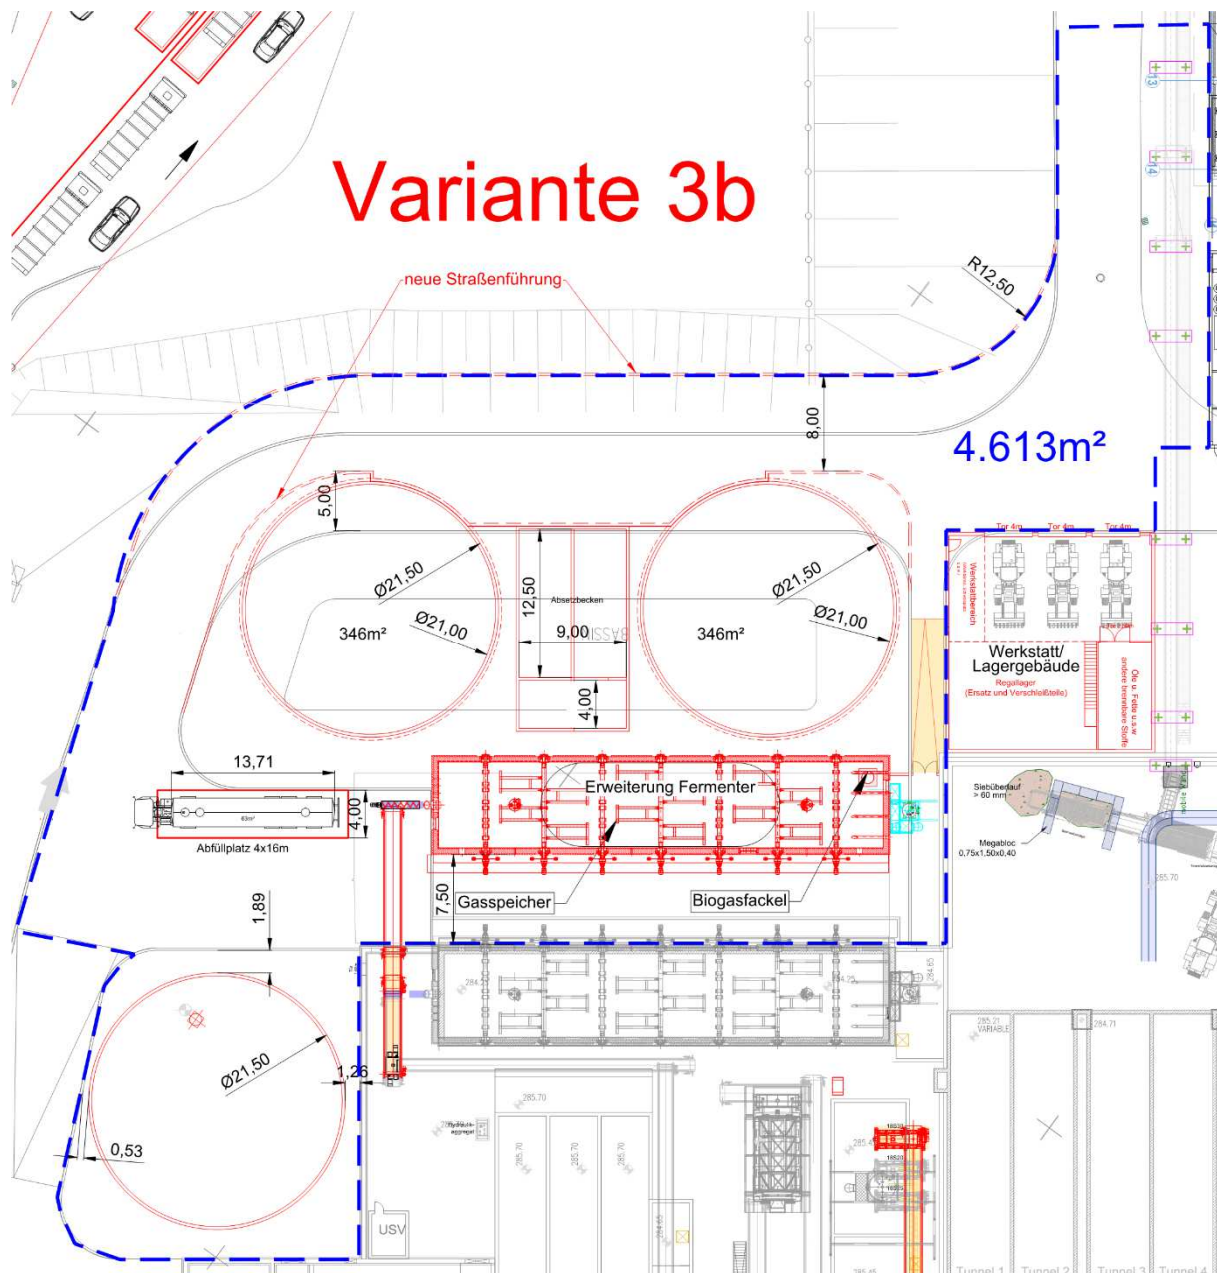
Plan der Minett Vergärungsanlage mit geplanten Erweiterungen Bereich Abfüllplatz Presswasser)
